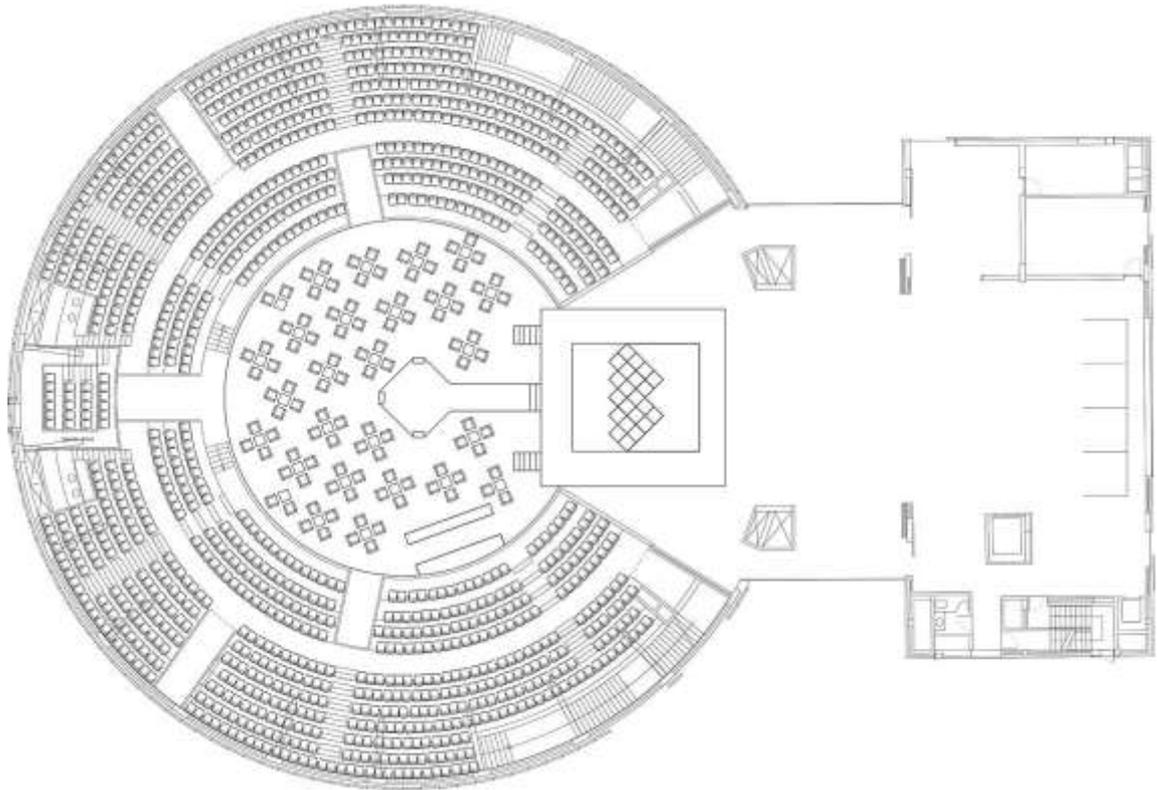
Planta del teatro con la escenografía base y boceto, por la autora.
